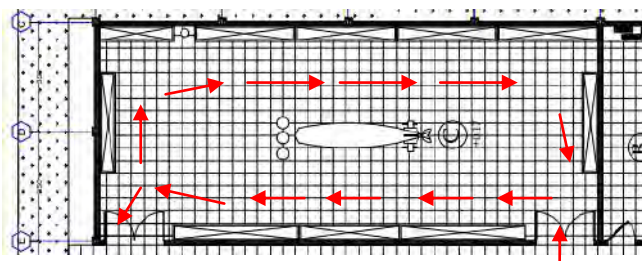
Denah dan alur sirkulasi pengunjung area hall
